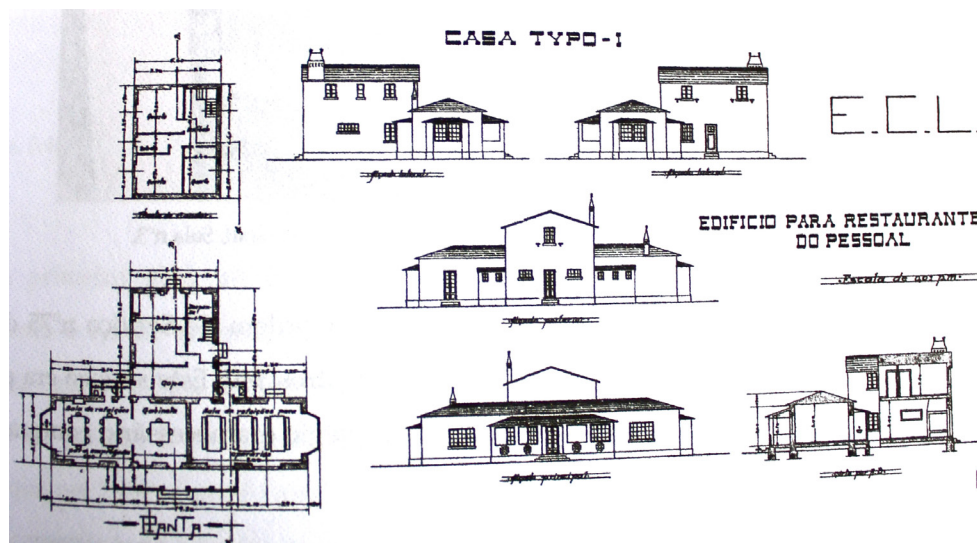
Planta 1º e 2º piso, alçados e corte transversal do edifício do Restaurante, s.d
